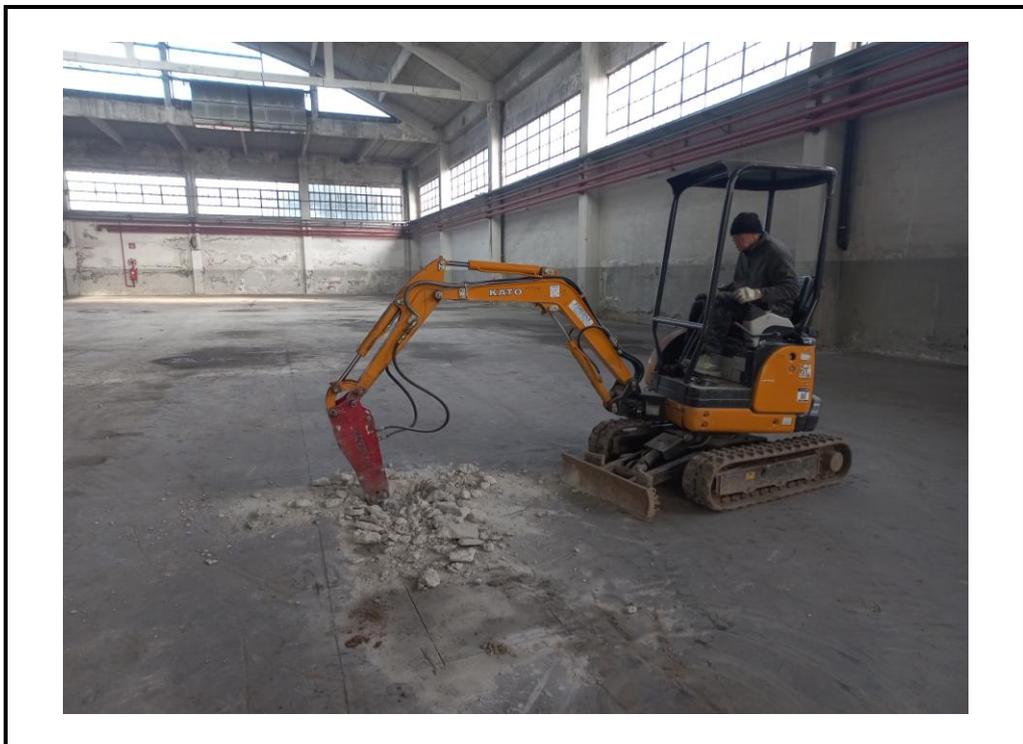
Fase di demolizione pavimentazione Pozzetto P1.
